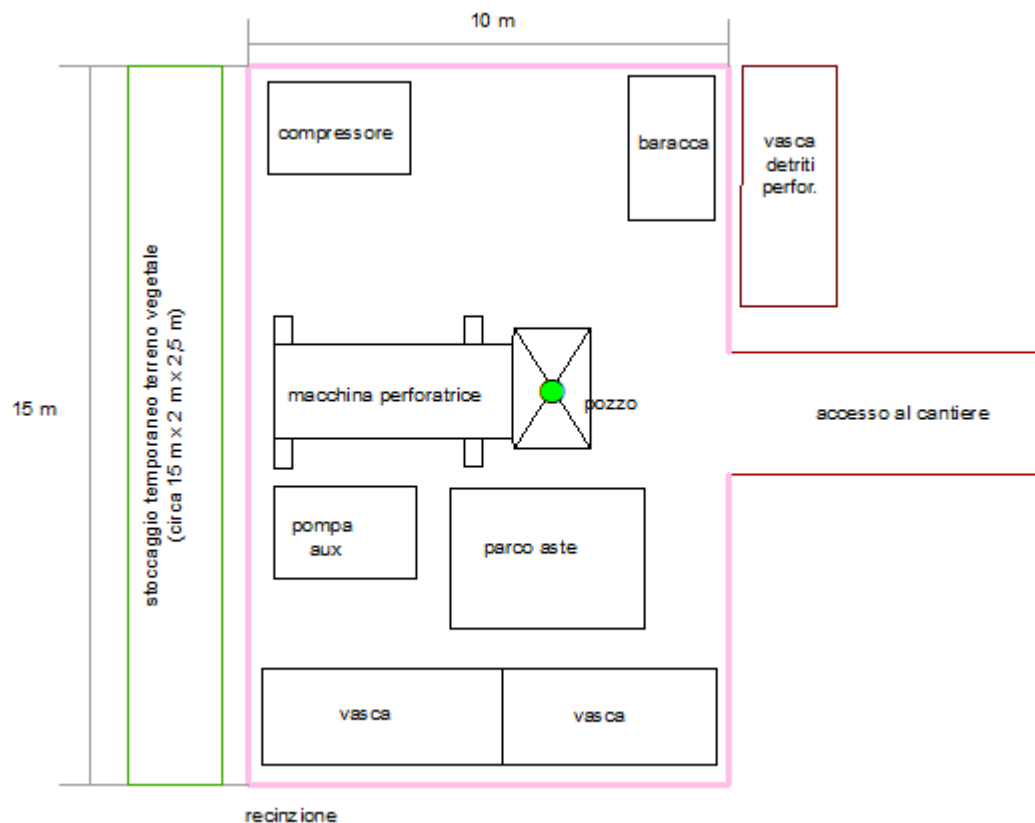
Layout di cantiere del pozzo 1 con i principali equipments (estratto da tavola di Allegato 1)
